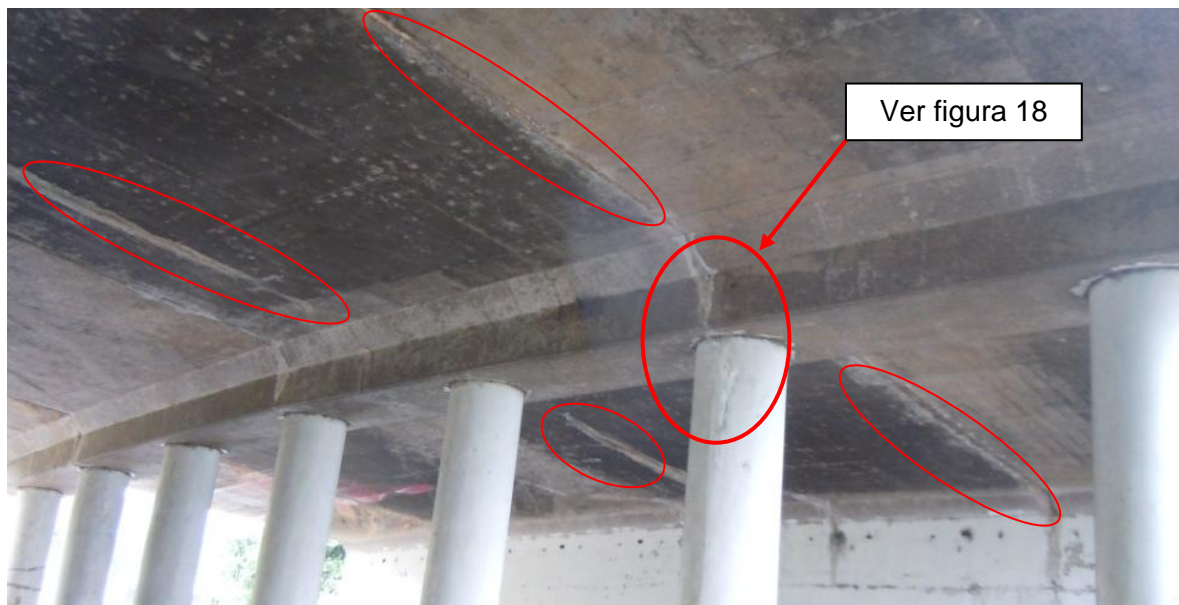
Grietas longitudinales con eflorescencia en la superficie inferior de la losa del puente.
